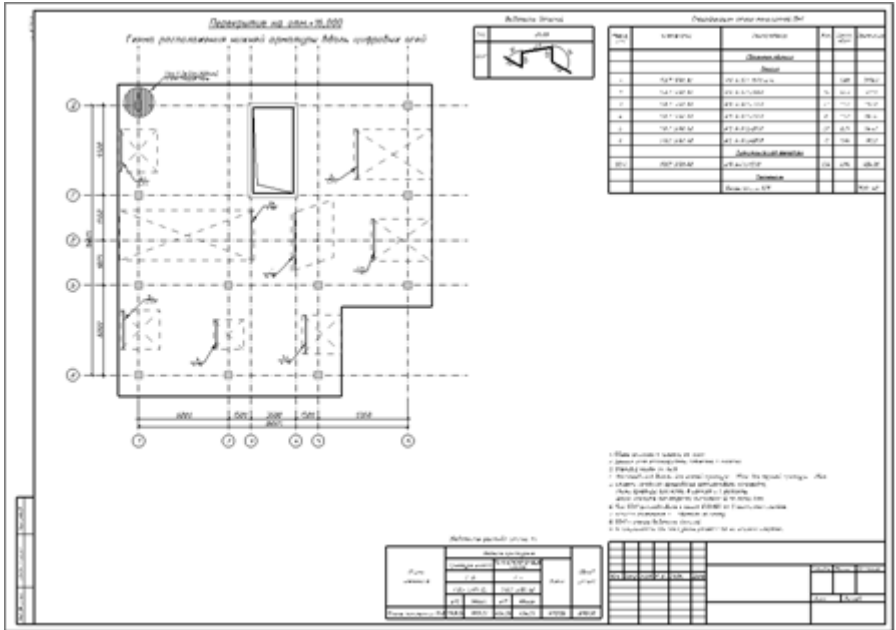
Креслення розташування арматури в плиті перекриття на позначці+16.000
